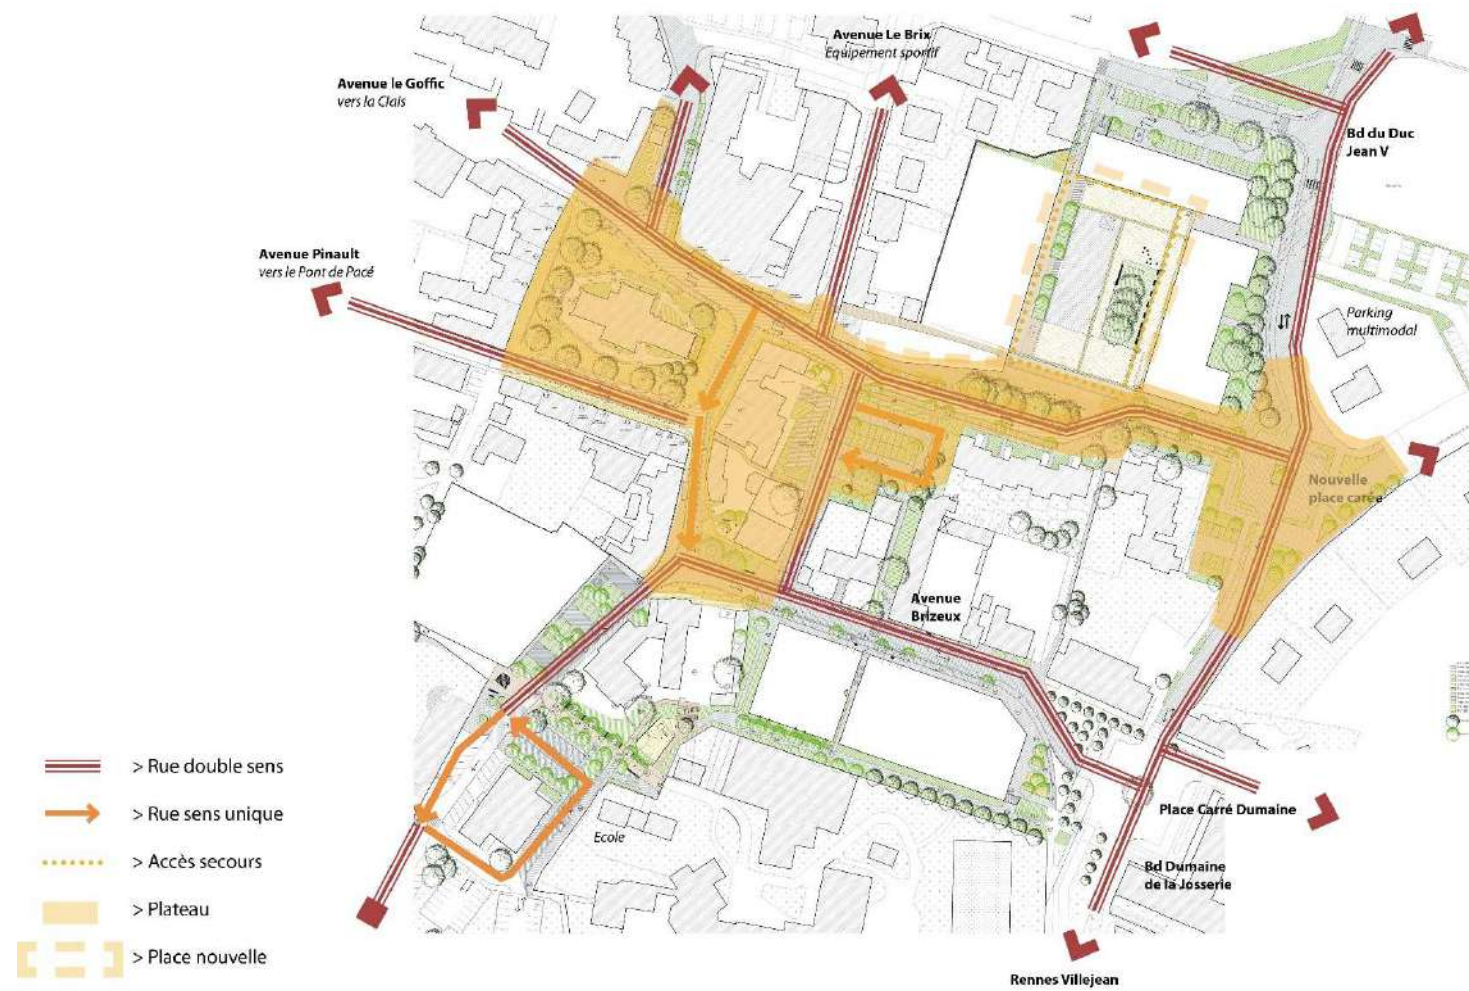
Plan des liaisons viaires au stade AVP – Place Saint-Melaine
